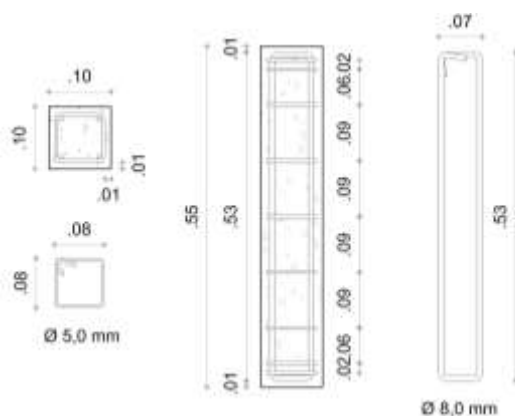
Detalhamento dos pilares (sem escala e cotas em metros)
